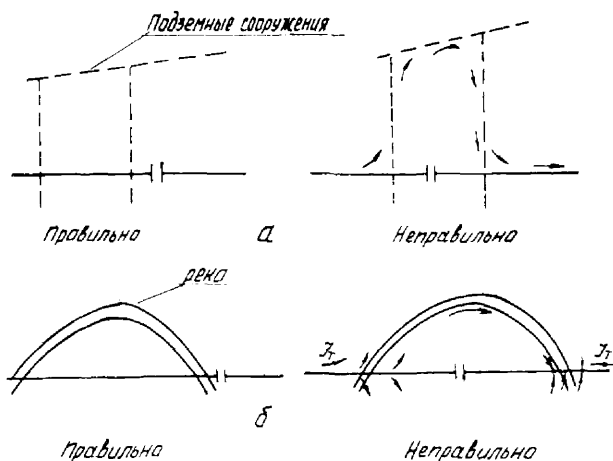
Установка изолирующих фланцев: а-при пересечении защищаемого трубопровода с другими подземными сооружениями; б-при пересечении трубопроводом реки
